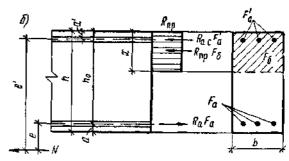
Схема усилий и эпюра напряжений в сечении, нормальном к продольной оси внецентренно-растянутого железобетонного элемента, при расчете его по прочности
